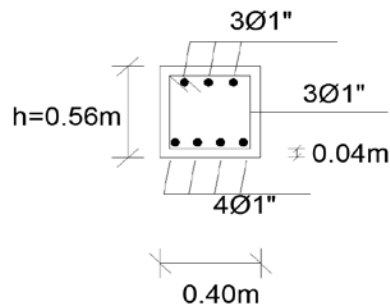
Detalle del acero de la viga acartelada. Fuente: Elaboracion Propia
